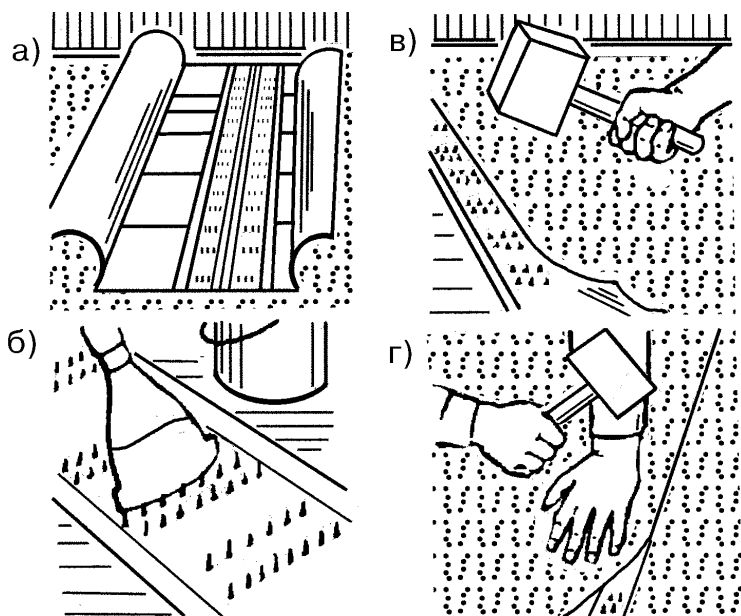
Плоские металлические планки с шипами для соединения ковровых покрытий пола
